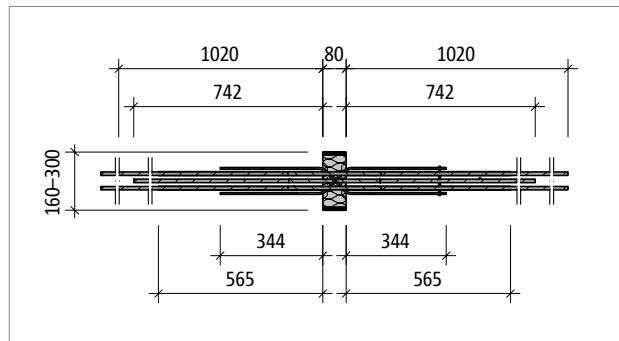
Schöck Isokorb® T Typ WL-M4: Produktgrundriss
